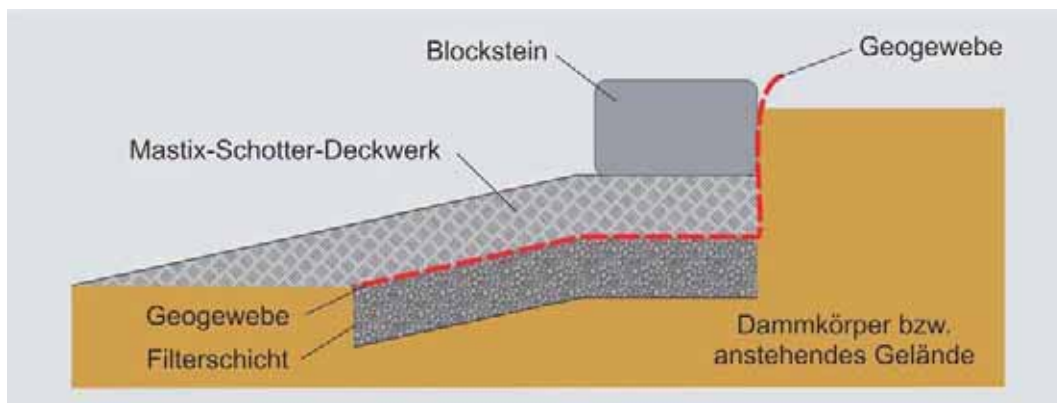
Ausführung des Randbereichs einer Überströmstrecke mittels Blocksteinen.
